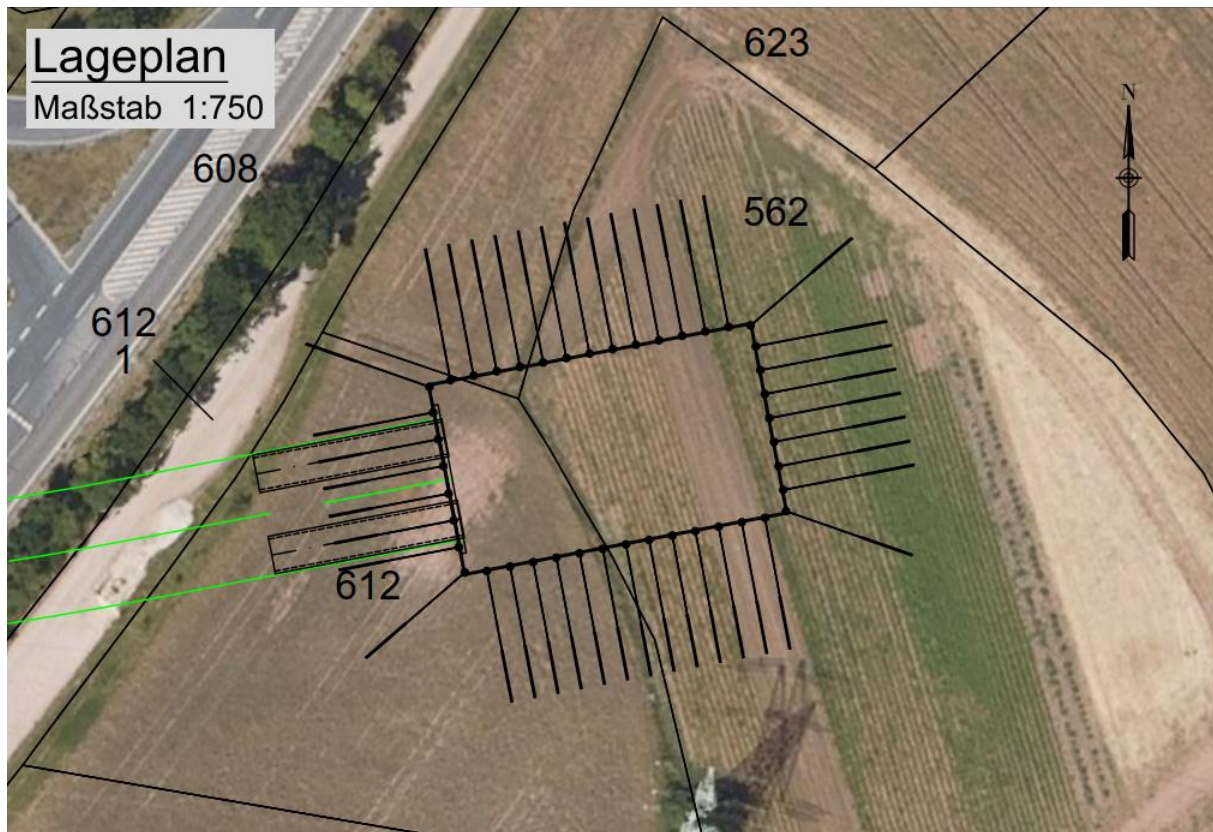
Planung Lage Startbaugrube gemäß Unterlage 7.3
